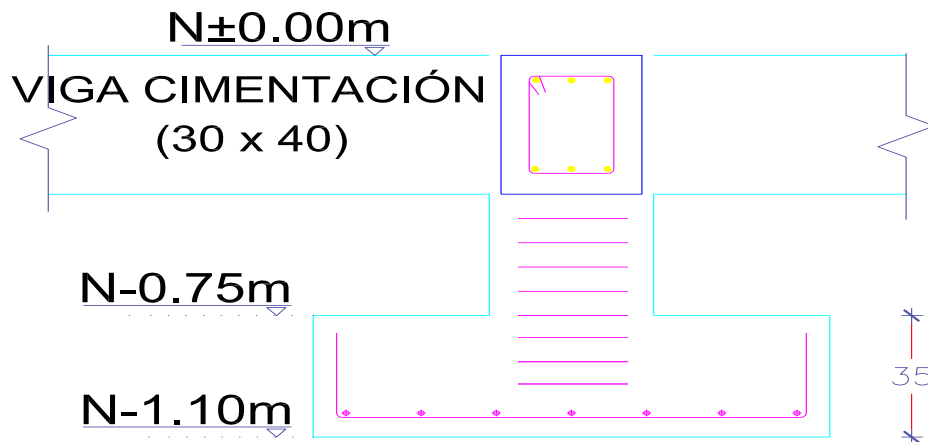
CORTE ZAPATA, COLUMNA Y VIGA DE CIMENTACION.
